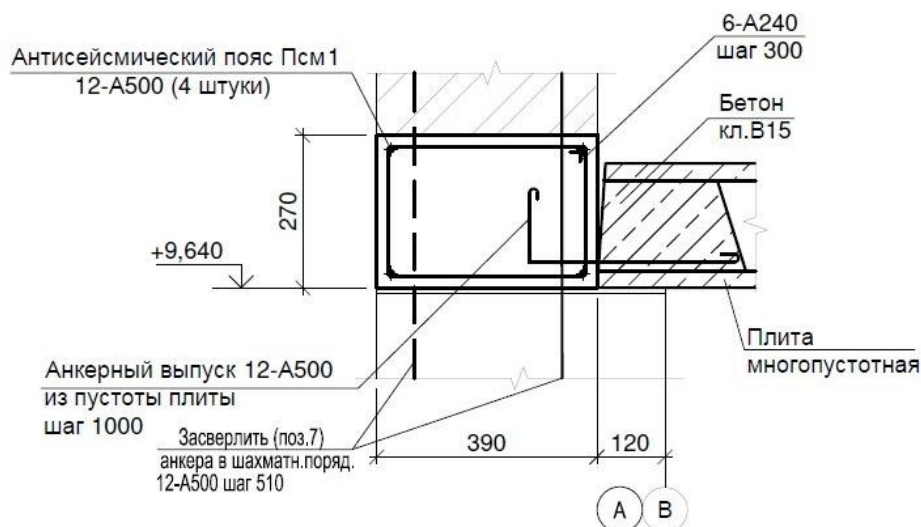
Антисейсмические пояса в уровне чердачного перекрытия
